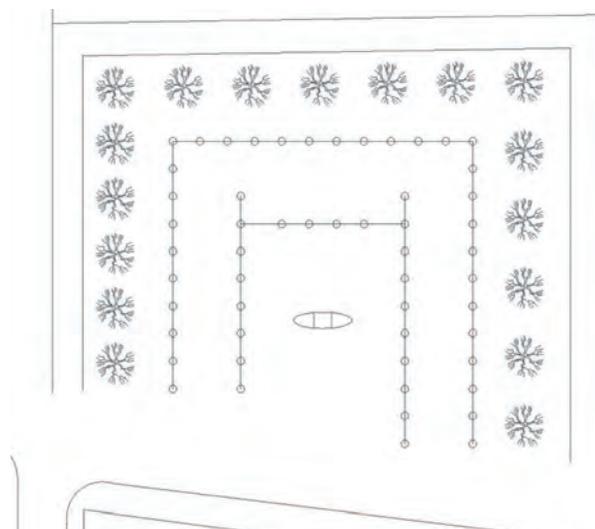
PLANO DE LA PLAZA DE FERIAS SEGÚN PROYECTO DE 1880
